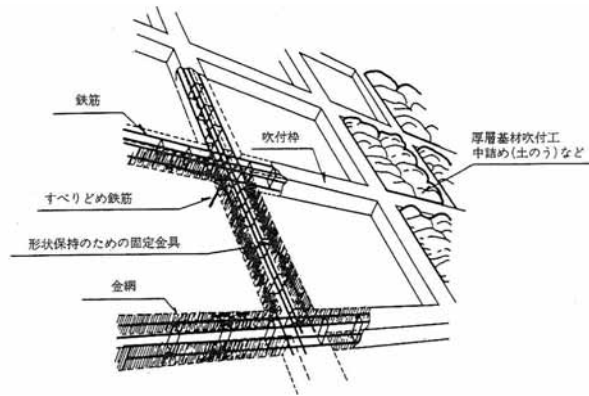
吹付枠工に使用するすべり止め鉄筋、金具類
